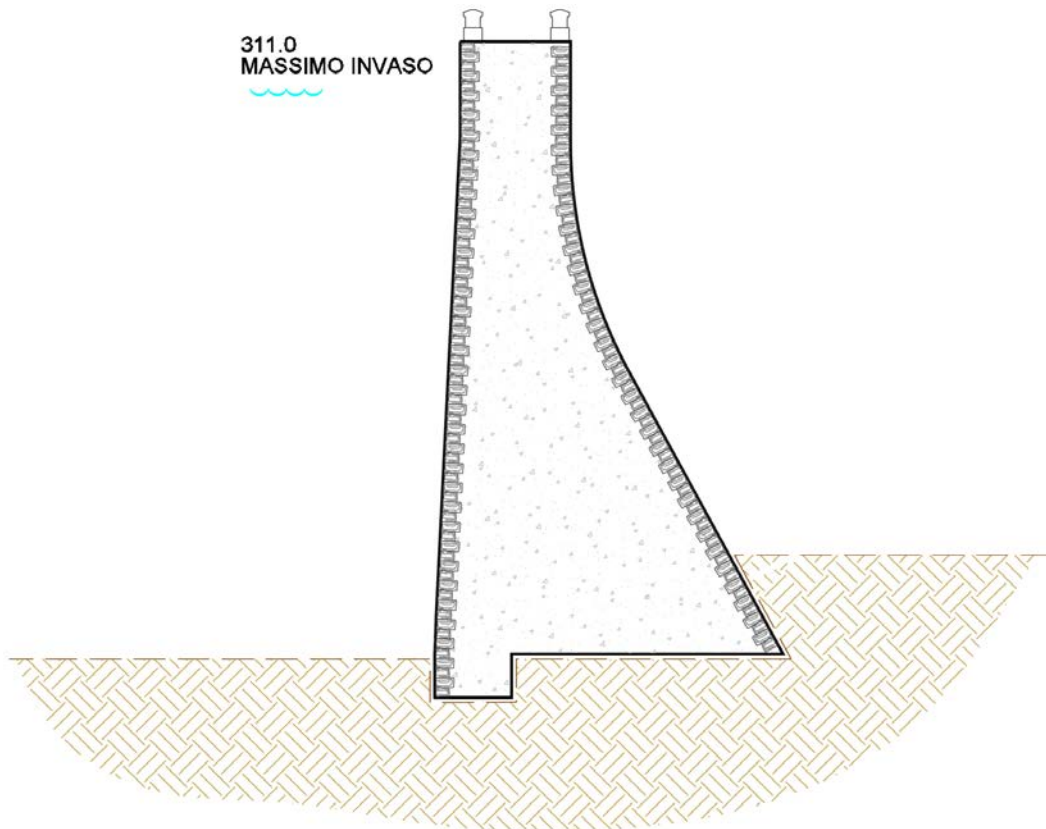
Diga di Pontecosi – sezione trasversale tipo di spalla
